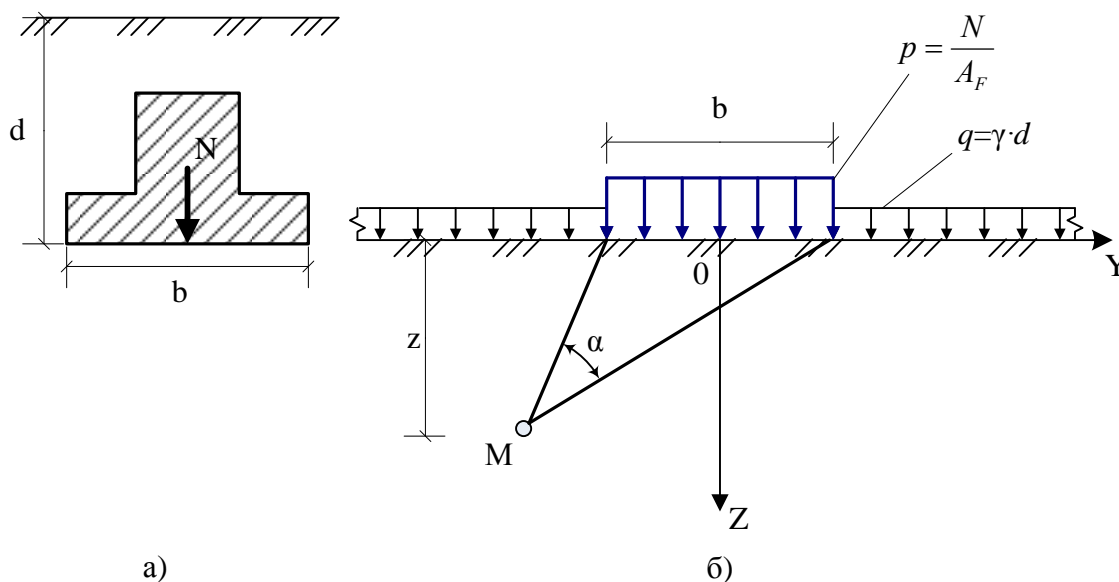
Расчетная схема к определению начальной критической нагрузки:
